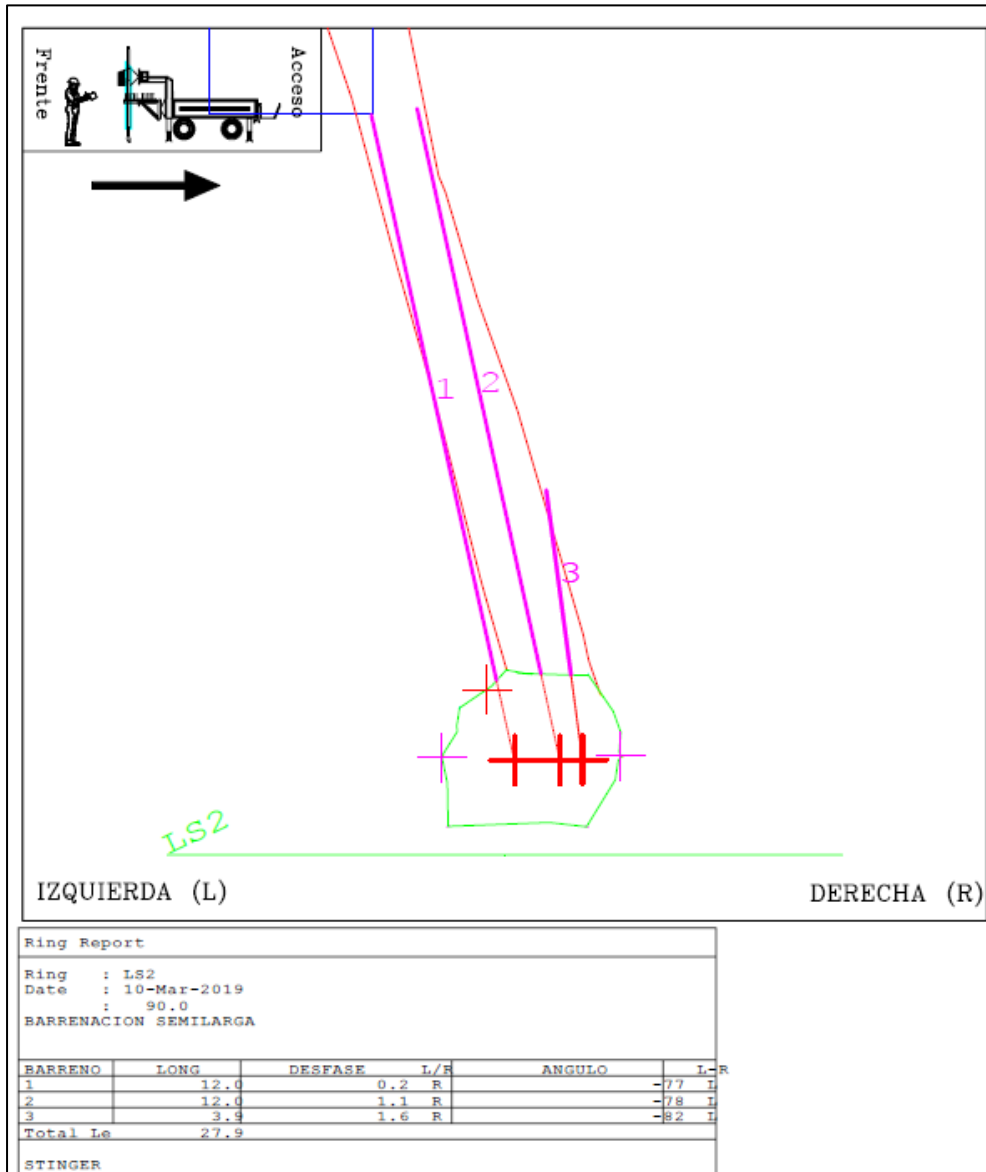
Vista en planta de un rebaje de barrenación semi larga.
